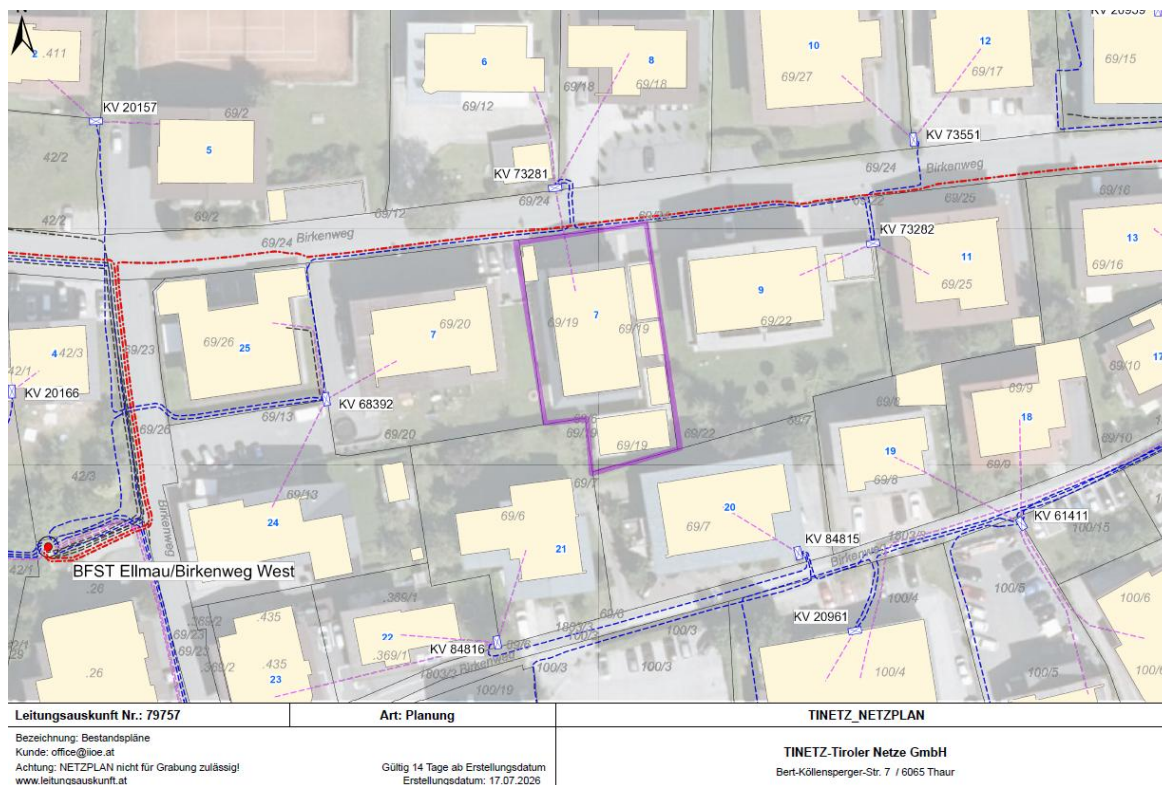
Leitungslageplan. TINETZ (v. 17.07.2026)
